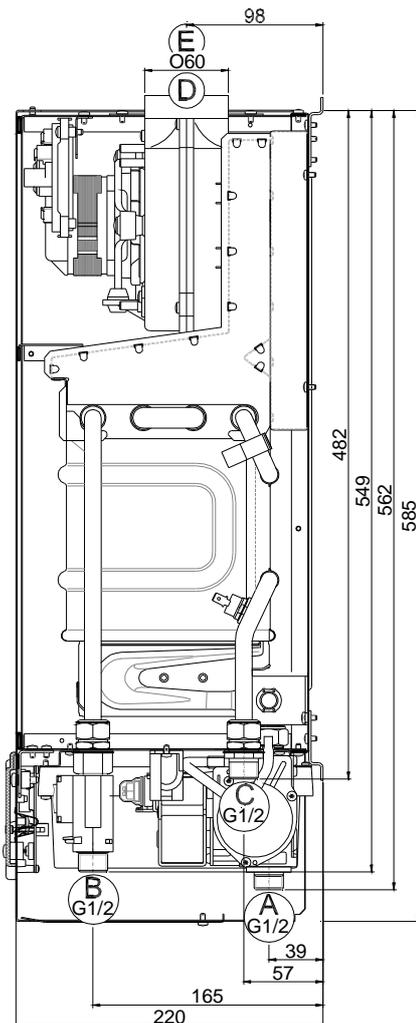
Le dimensioni principali di installazione (in mm)
